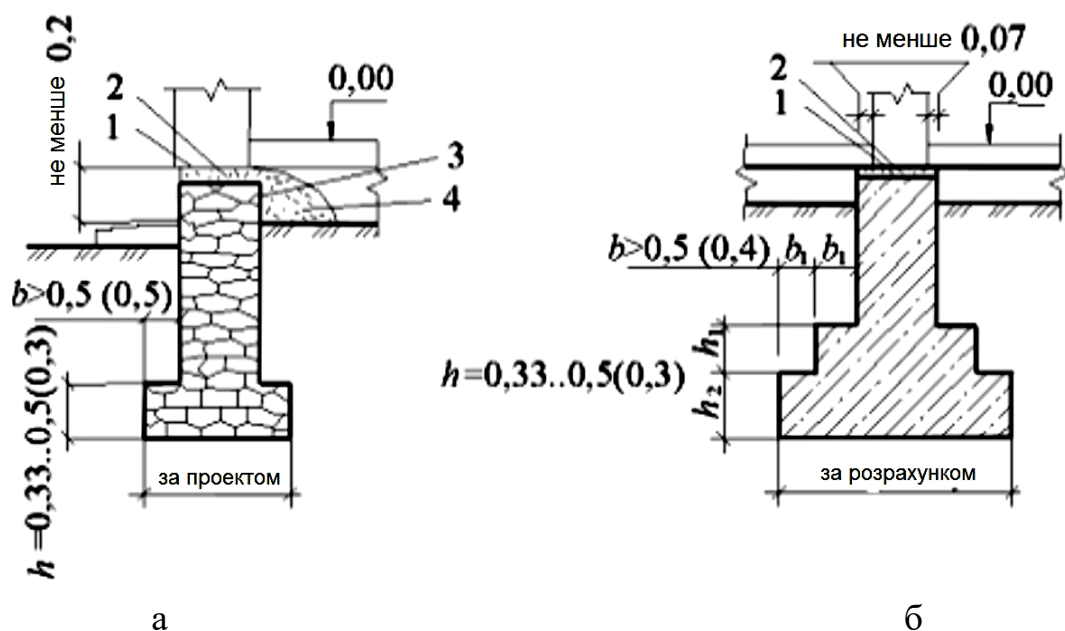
Бутові і бутобетонні фундаменти з уступами: а – під зовнішню стіну;
